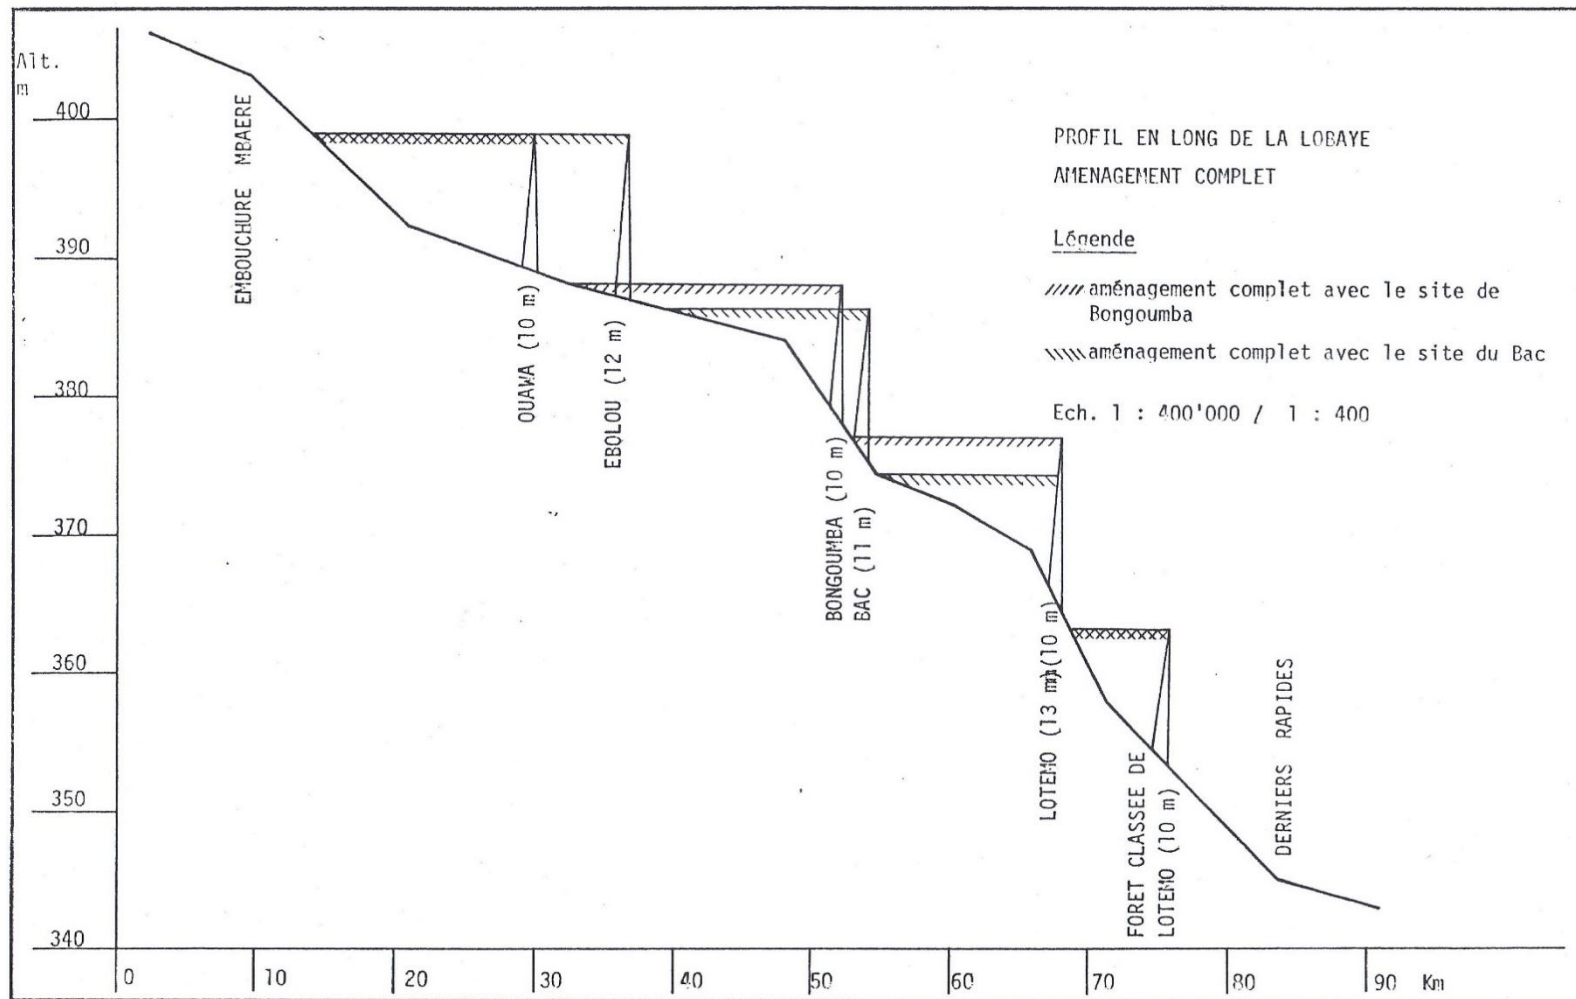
Coupe longitudinale de l'aménagement de planification en cascade du bassin versant Lobaye
